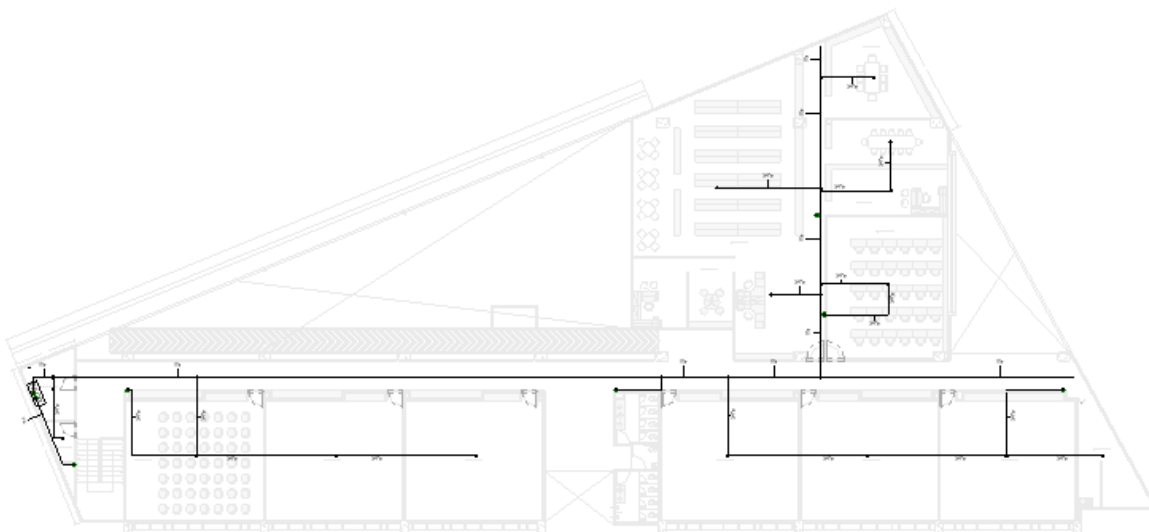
Vista en planta Piso 2 - CCTV – ALARMA DE INTRUSIÓN
